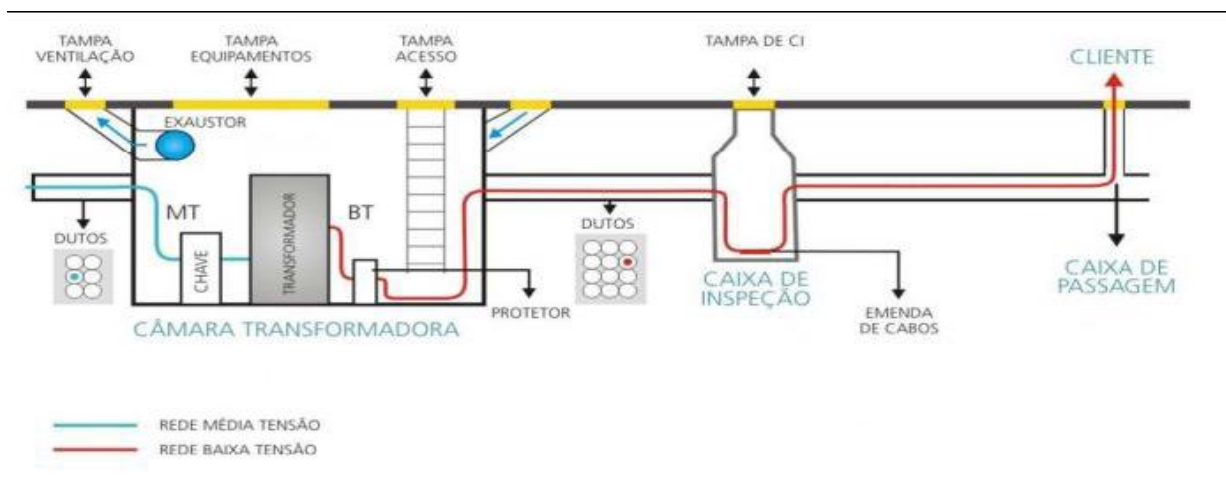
Infraestrutura padrão da Rede Subterrânea
